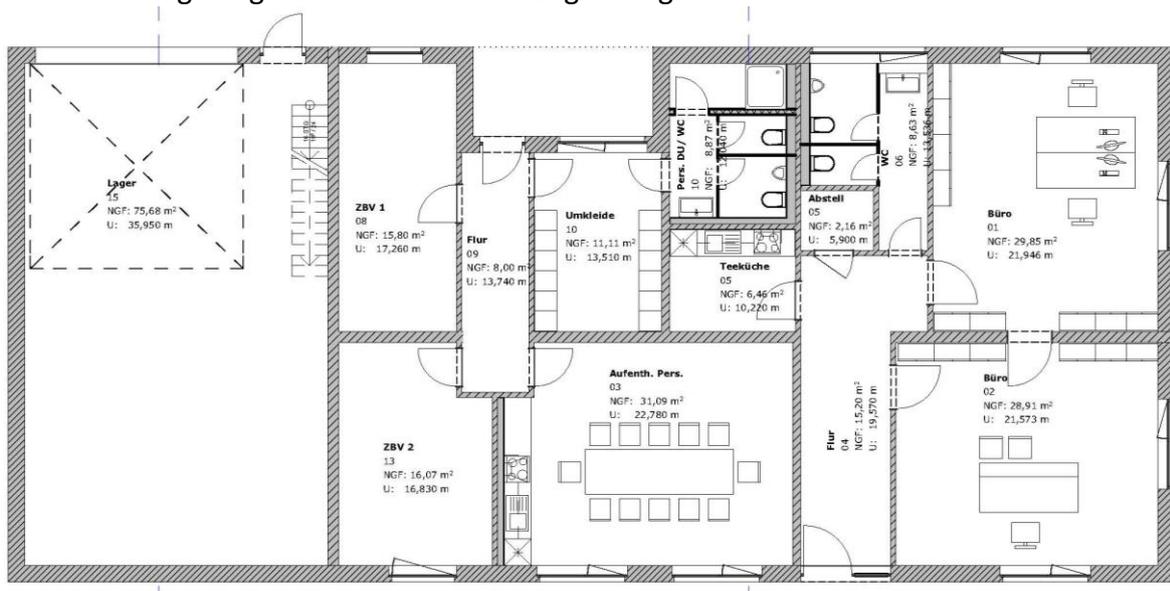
Planung Bürogebäude Grundriss EG
